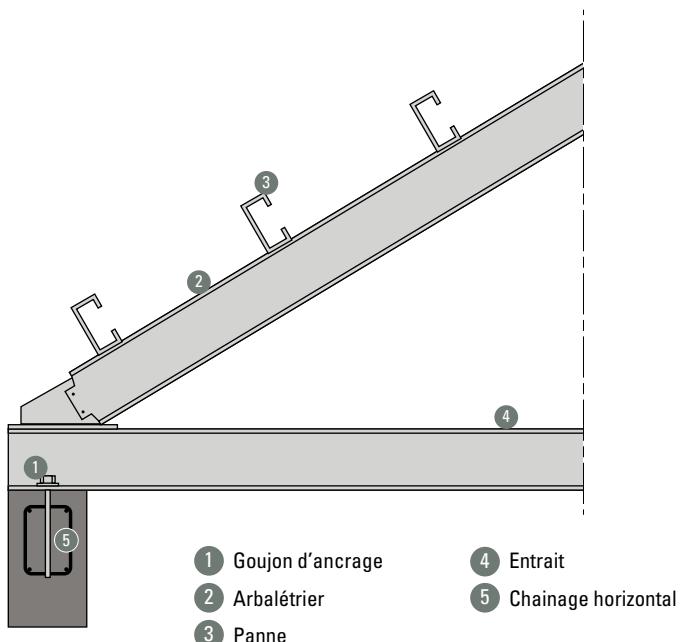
Exemple d'ancrage de la charpente dans le béton par goujon d'ancrage
